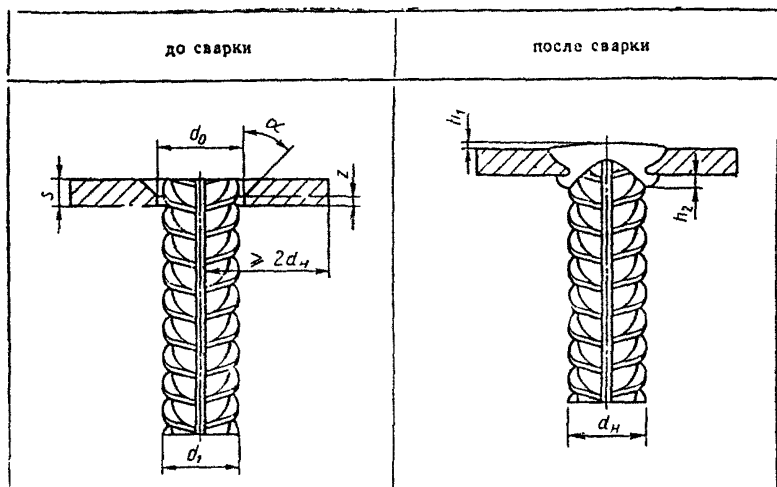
Конструкция таврового соединения, выполняемого ручной дуговой сваркой валиковыми швами в раззенкованное отверстие
